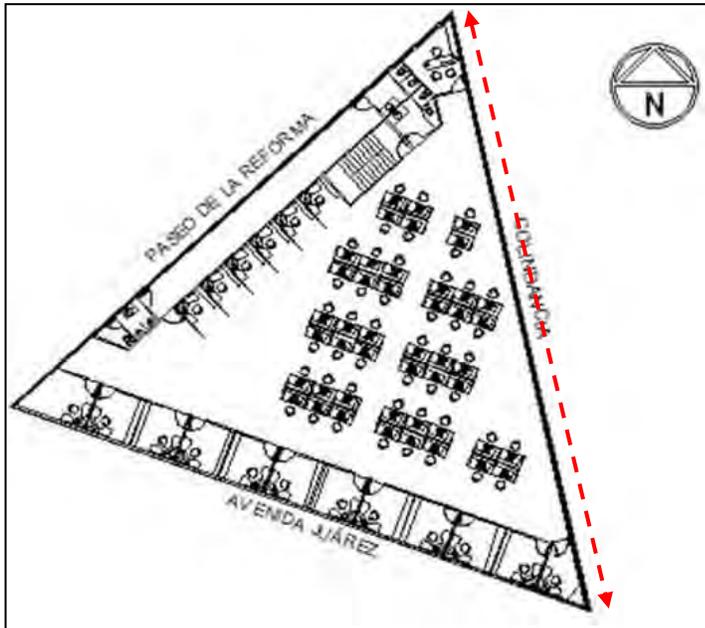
Planta del piso 25 de la Torre Prisma donde se indica la apertura de ventanas en la fachada Este.
